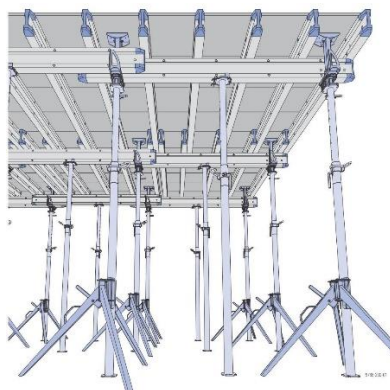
Конструкция опалубки перекрытия на телескопических стойках
